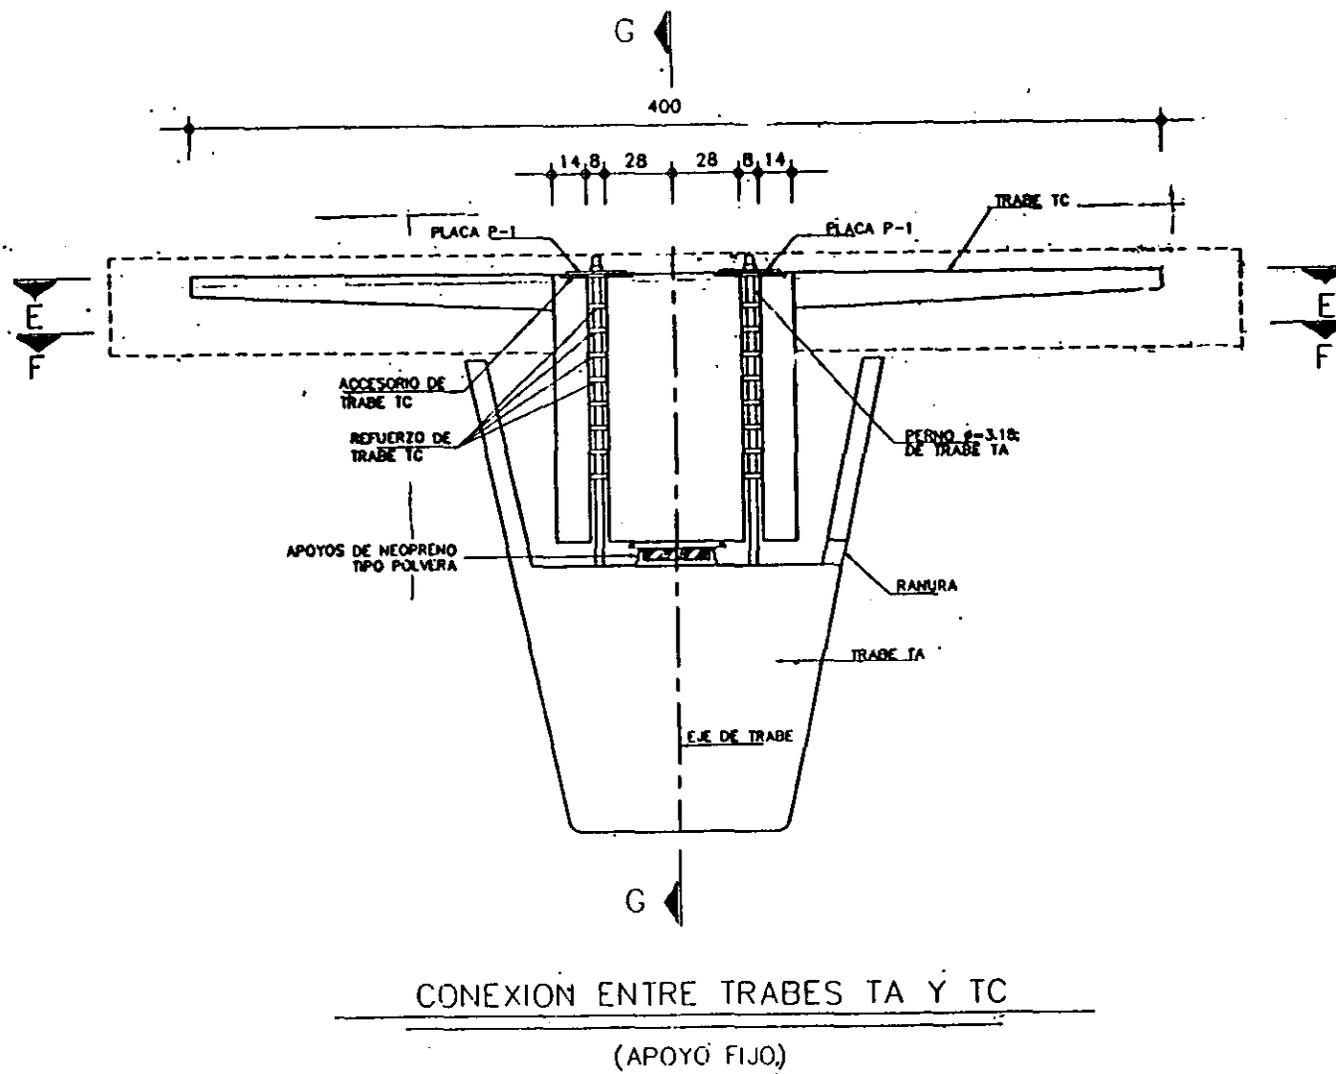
C. Sección Transversal de Trabe de Apoyo.
